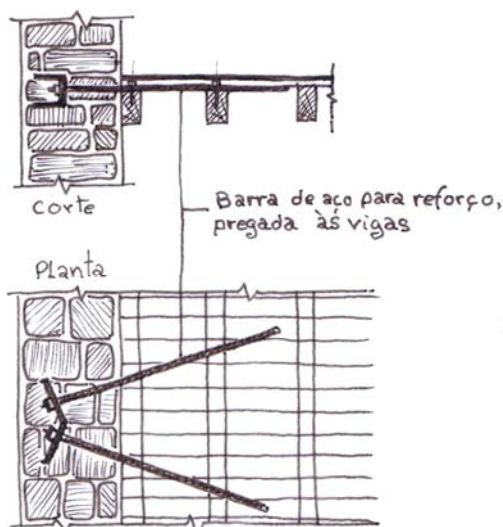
a | Com barras de aço pregadas às vigas do pavimento de madeira (antigas ou novas)
